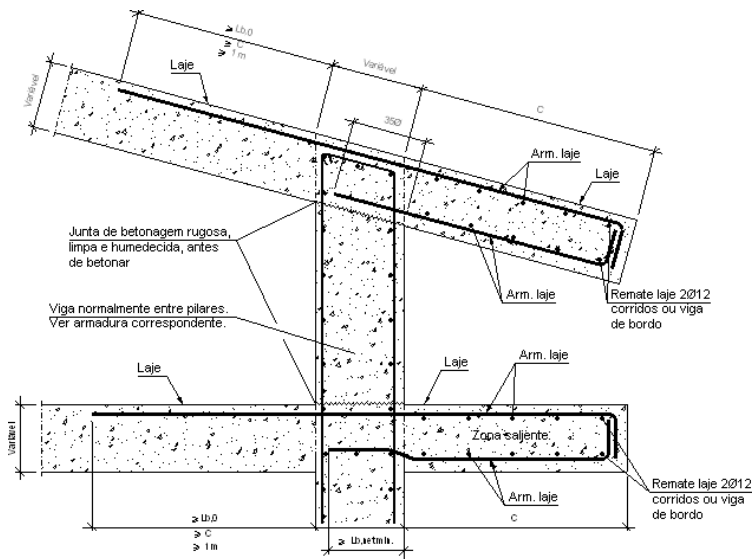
(a) - Corte transversal de uma laje de cobertura contínua em consola [10]
